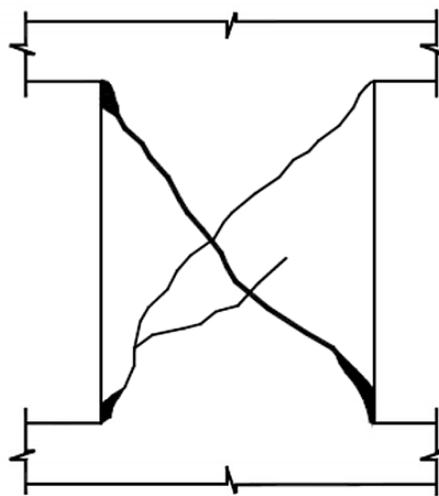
Fisuras de cortante en paredes de concreto reforzado (Hurtado, 2014).
